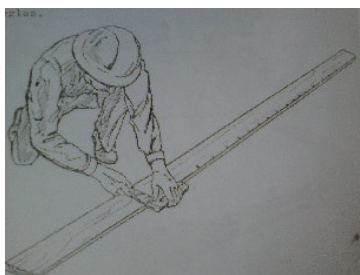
Trabajador preparando un escantillón (SENCICO 1986)
